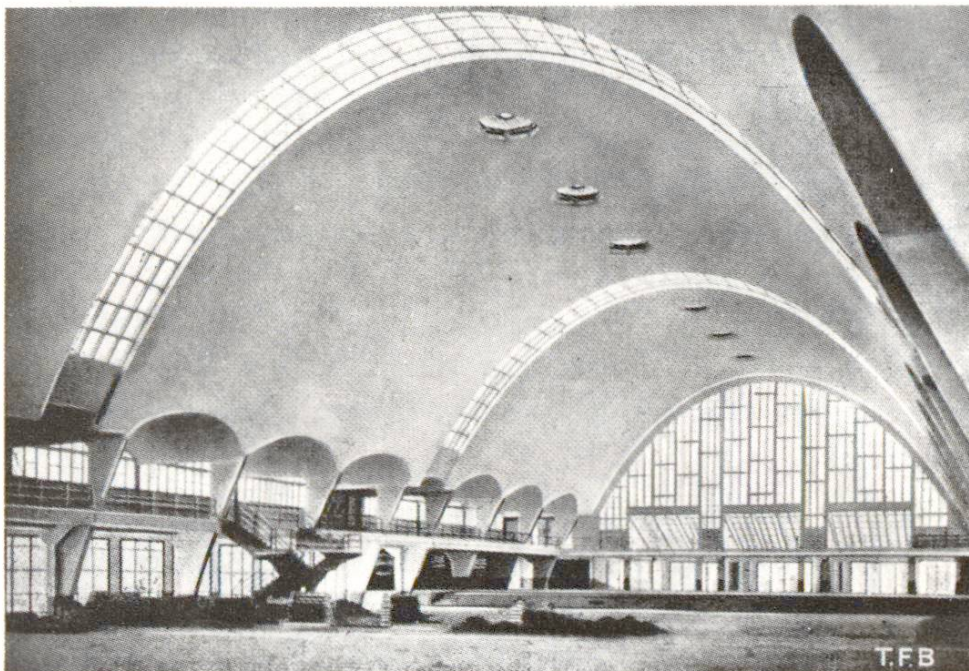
Halle centrale à Reims (architecte M. Maigrot). Longueur 110 m, portée 38,3 m, hauteur 19,5 m.
